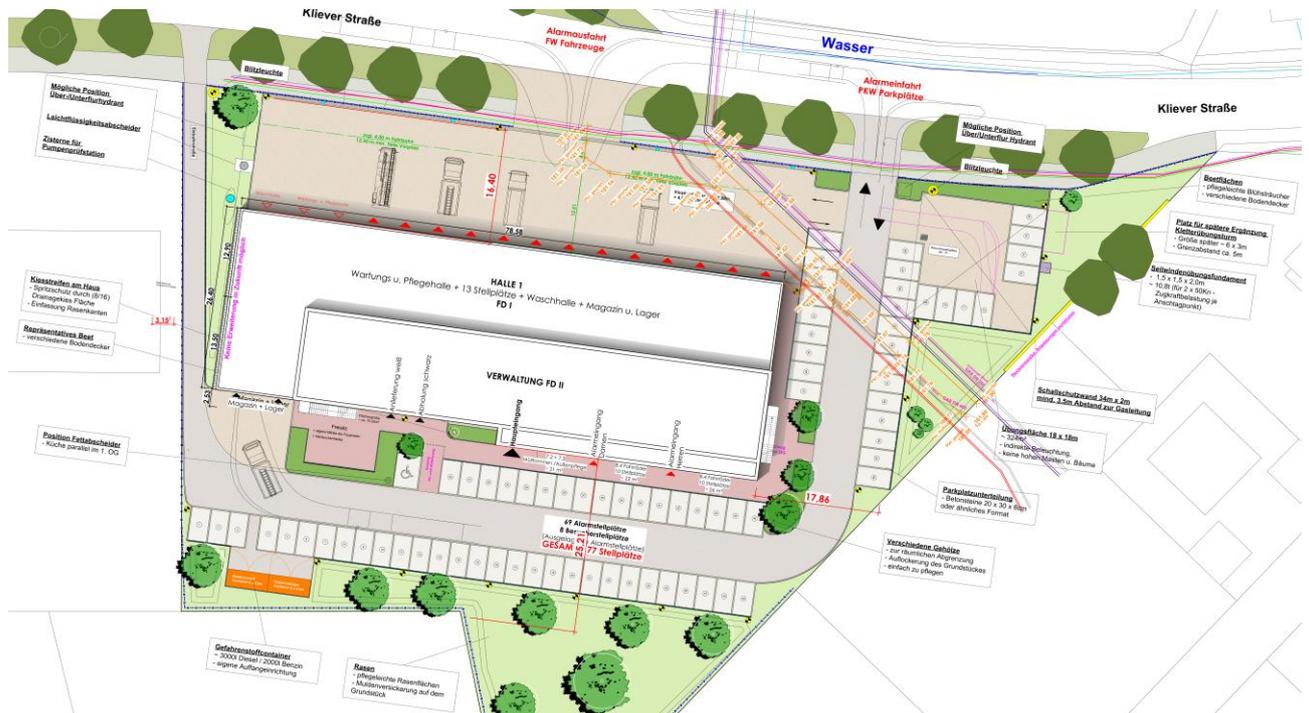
Lageplan, Plan Nr. 500-200-LAG (nicht maßstäblich)
